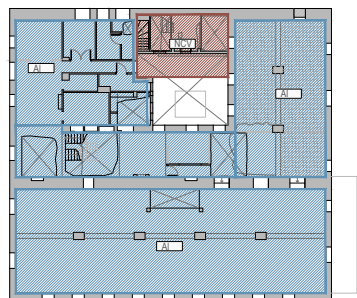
Programa de planta segunda (alternativa 1)
